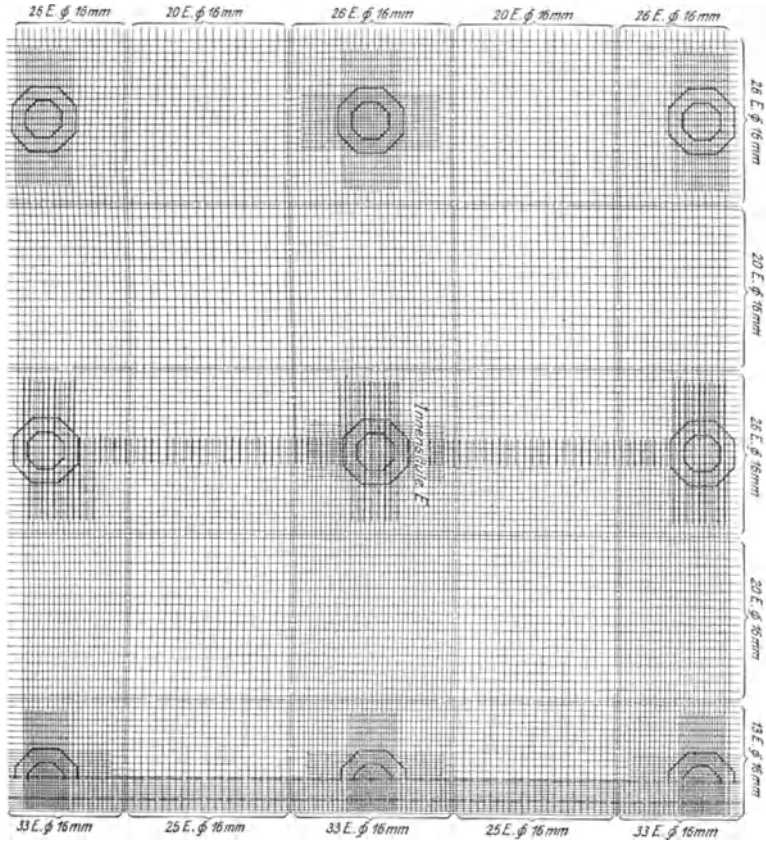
Grundriß mit Eisenverteilung im Obergeschoß (Zweiwegesystem).
